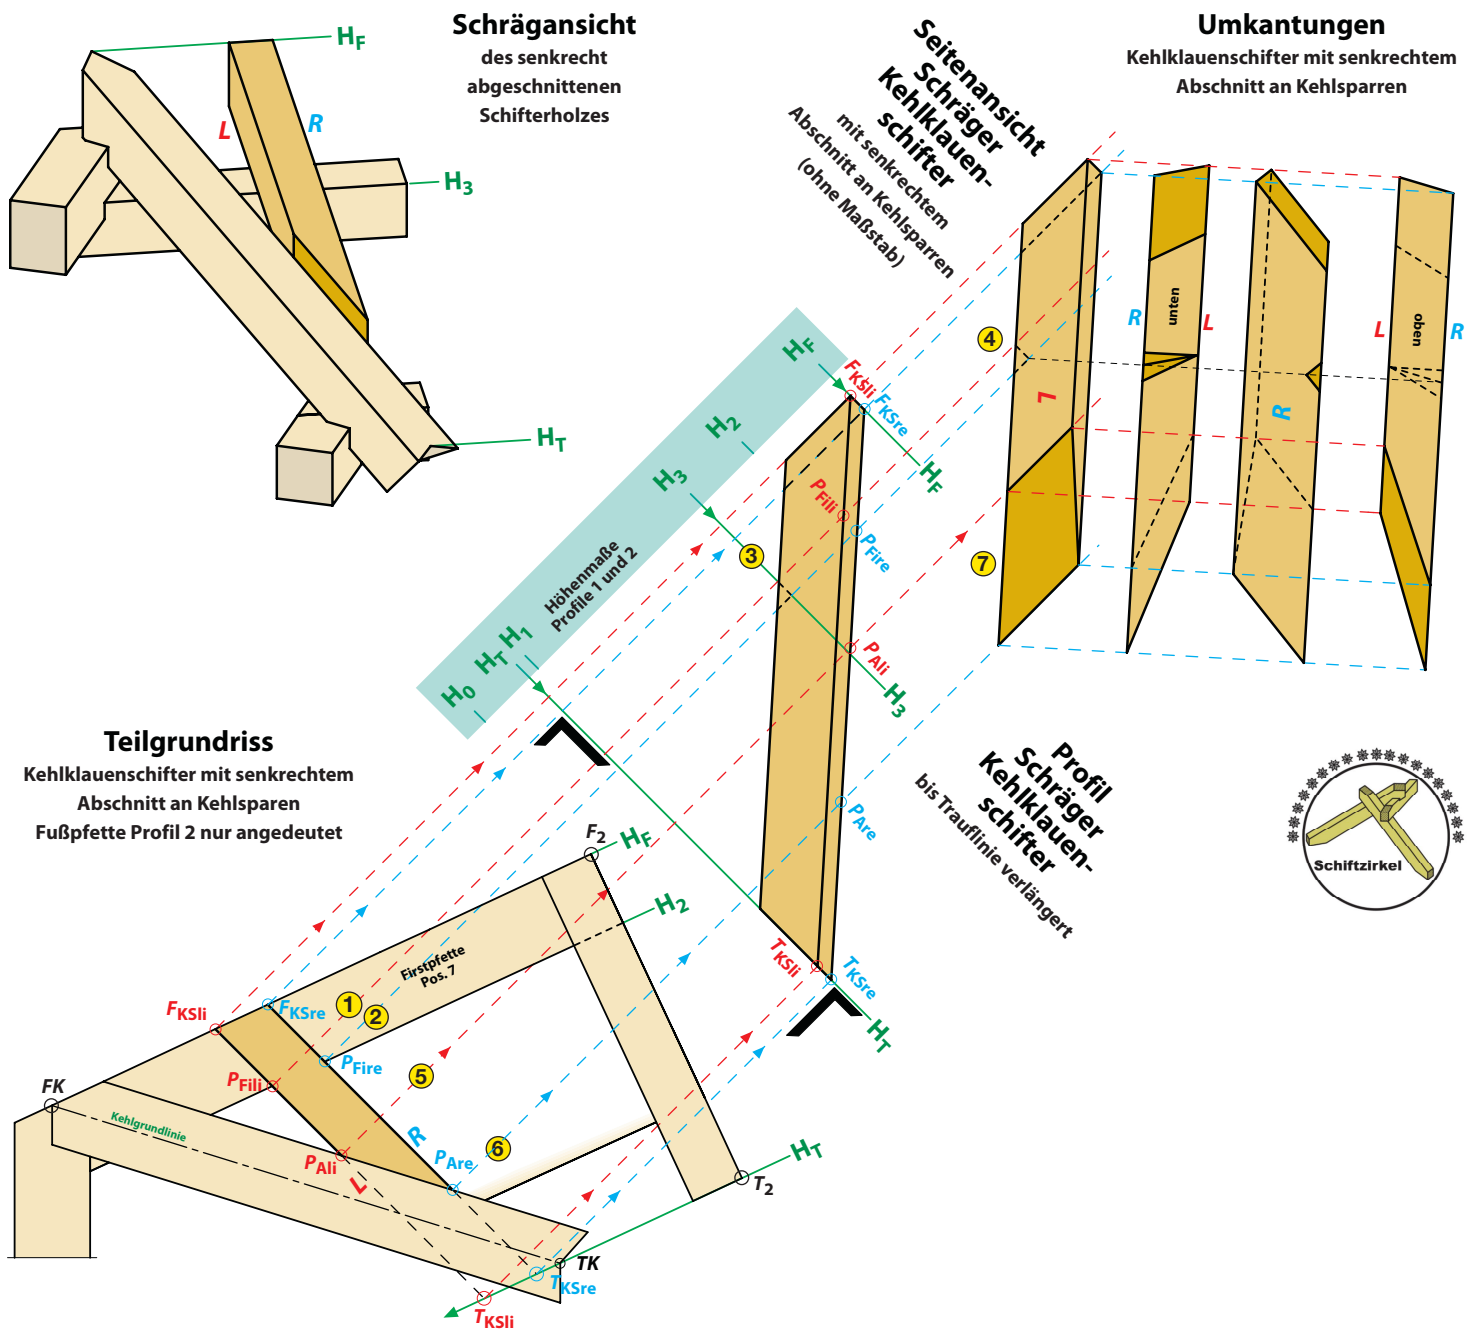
Festlegung der Lage der rechten Kante des schrägen Kehlschifters im Grundriss und Antragen der wahren Schifterbreite
